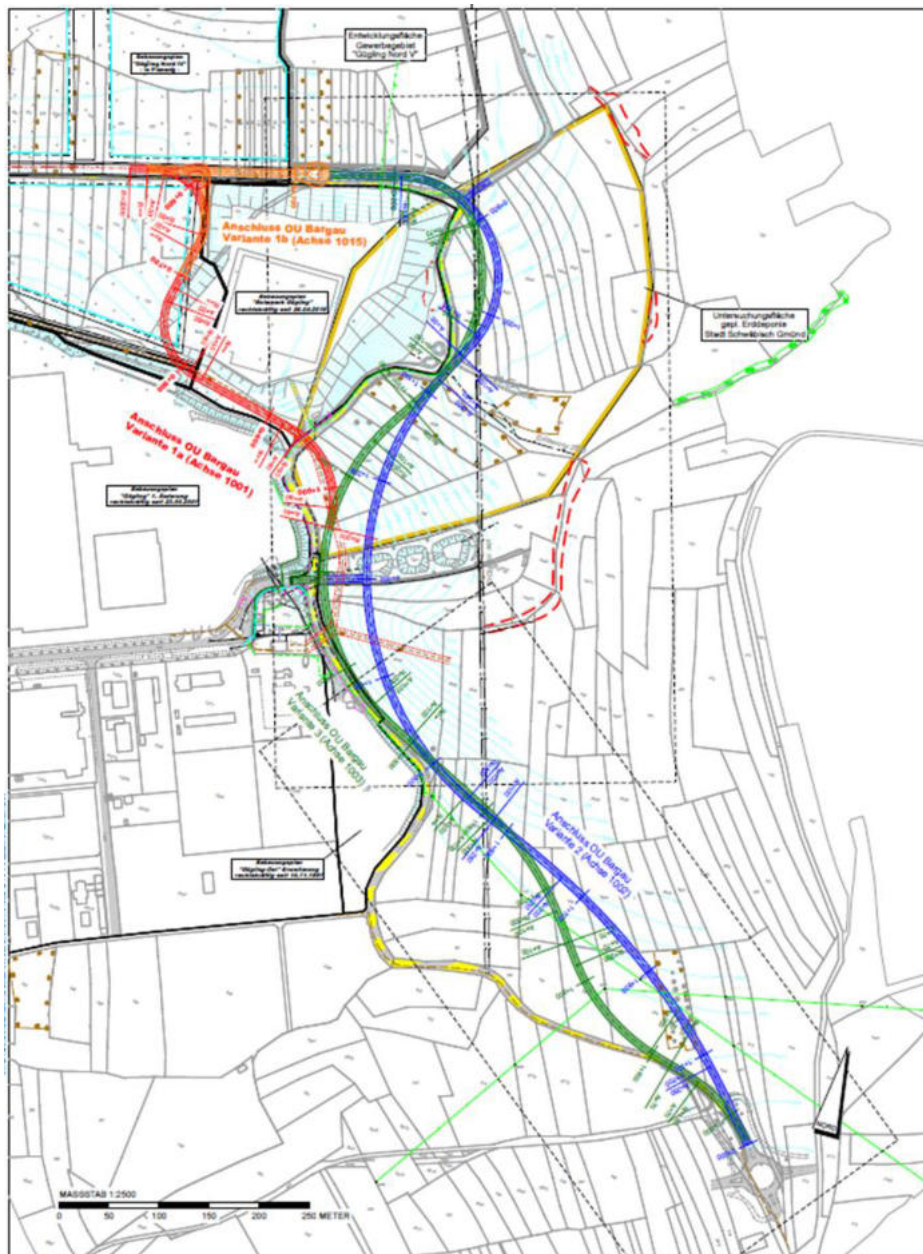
Trassenvarianten; Quelle: Bebauungsplan Nr. 540 "Anbindung Gügling an die OU Bargau", Begründung gem. § 9 (8) BauGB, StadtLandIngenieure 12.12.2019
